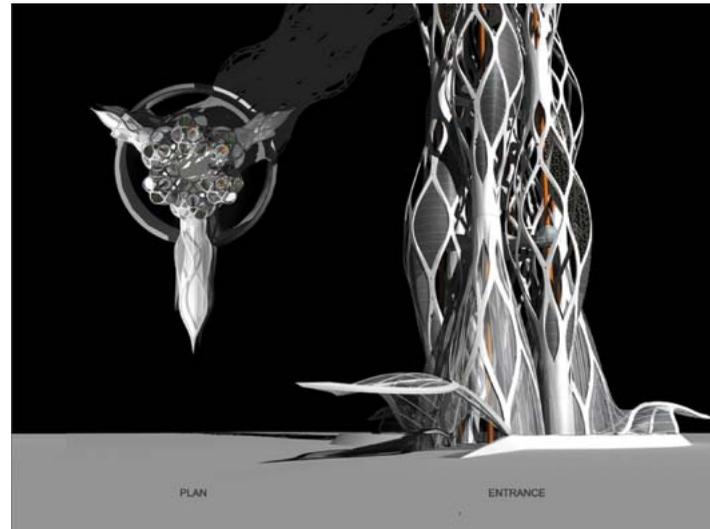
• Planta arquitectónica y alzado del acceso principal al cementerio.
